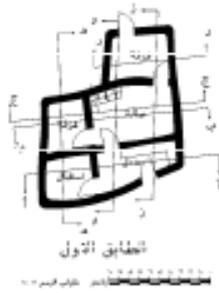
مسقط أفقي للطابق العلوي للدار رقم (1)
